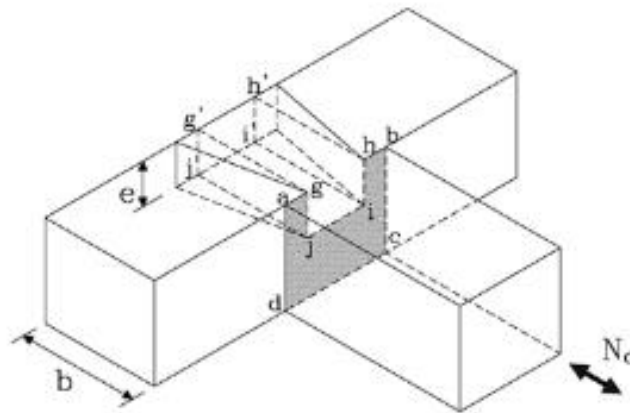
Ensamble de cola de milano Tomado de. [Diseño y cálculo de uniones en estructuras de madera, documento de aplicación del CTE, Maderia Construcción sociedad española de la madera, Tipos de anclaje en cola de milano. Recuperado de. http://ego.in.com/wp-content/uploads/2017/04/Guia-calculo_uniones_estructuras.pdf](http://ego.in.com/wp-content/uploads/2017/04/Guia-calculo_uniones_estructuras.pdf)
